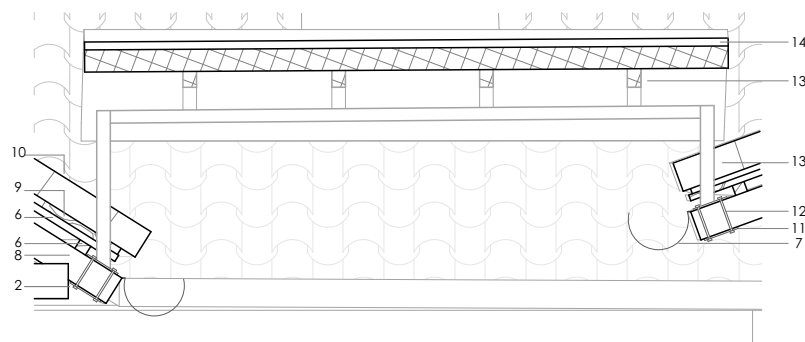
Detalle Constructivo 02. ESC 1:50
